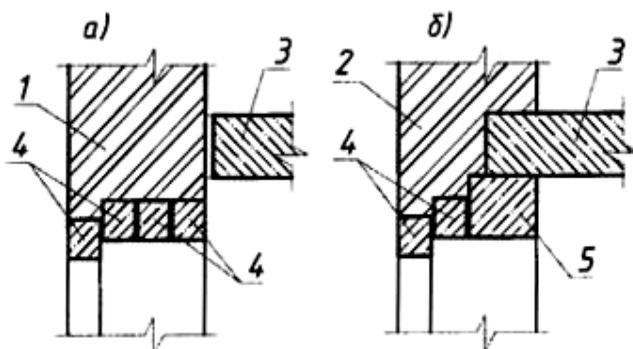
Устройство проемов в каменных стенах с применением сборных железобетонных пере­мычек:
